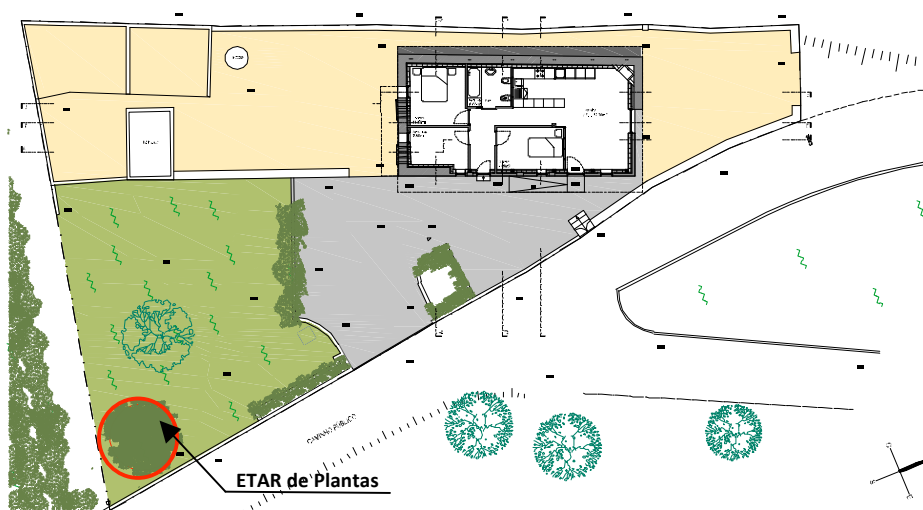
Local previsto para a instalação da ETAR de Plantas
